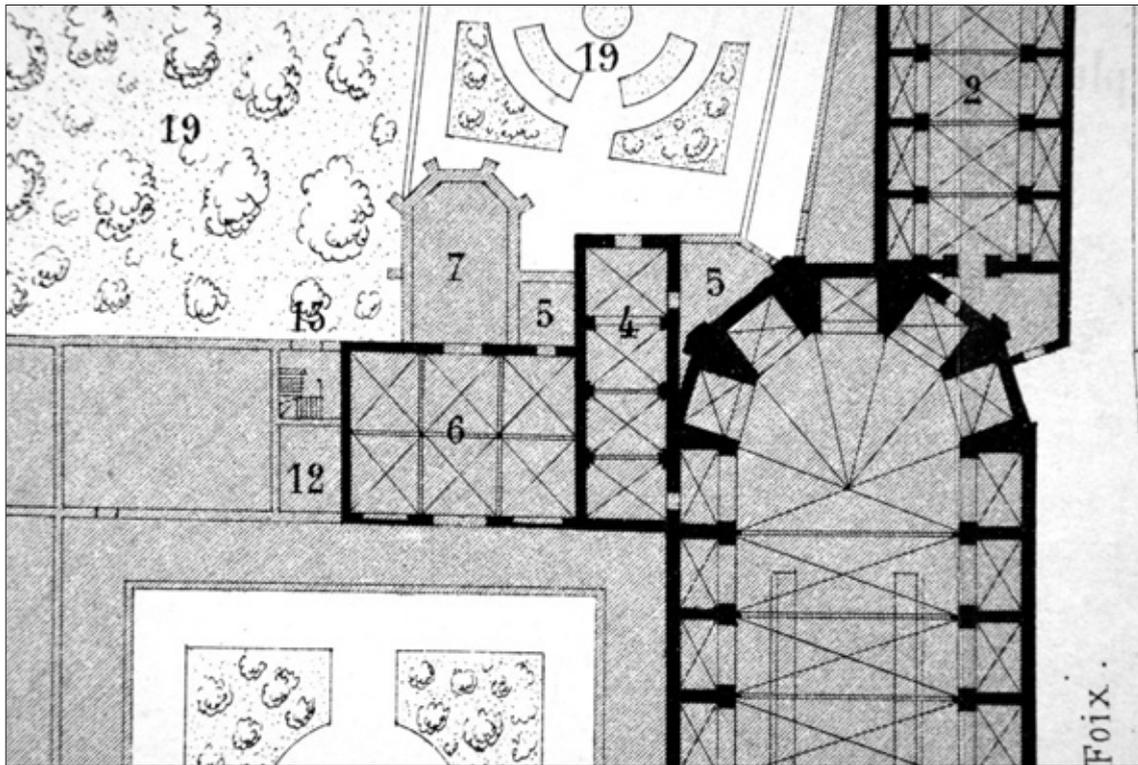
PLAN GÉNÉRAL DE L'ANCIEN MONASTÈRE DES CORDELIERS, 1876, planche 1, détail. *Plan de J.-J. Esquié.
